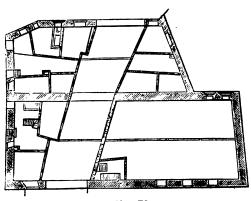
Fährthor. Grundriss. 1:500.
